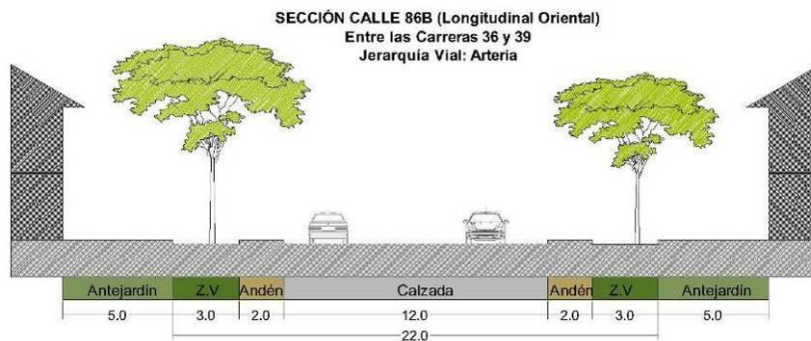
Sección vial propuesta Longitudinal Oriental Calle 89 entre carreras 36 y 39
